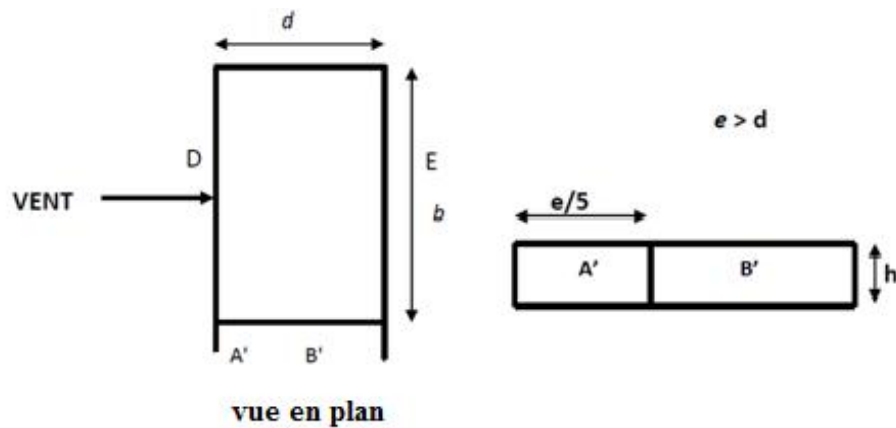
Vue en plan et vue en élévation, sens XZ.
